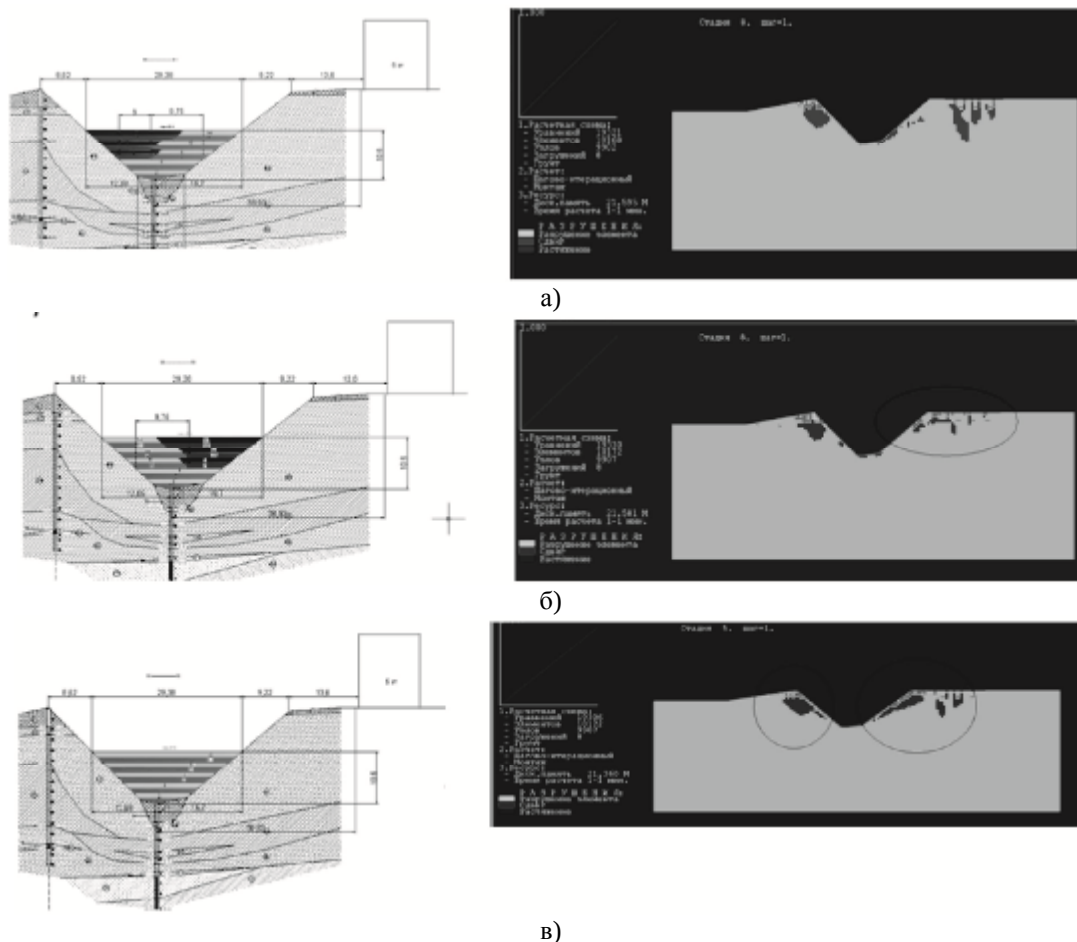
Схемы отсыпки грунта и соответствующее напряженно-деформированное состояние грунтового массива оврага: а) вариант 1; б) вариант 2; в) вариант 3
